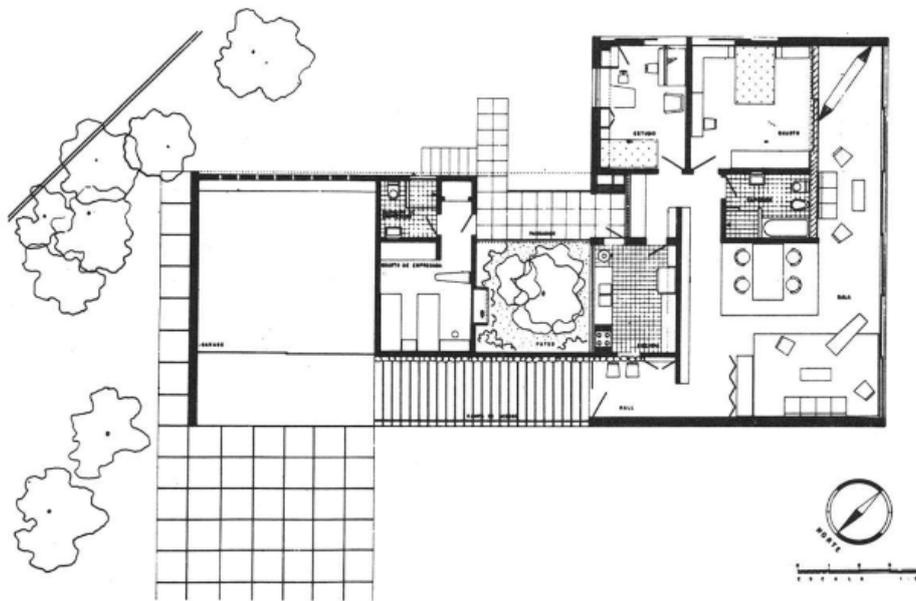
planta de la Casa Carmen Portinho, Revista Projeto
